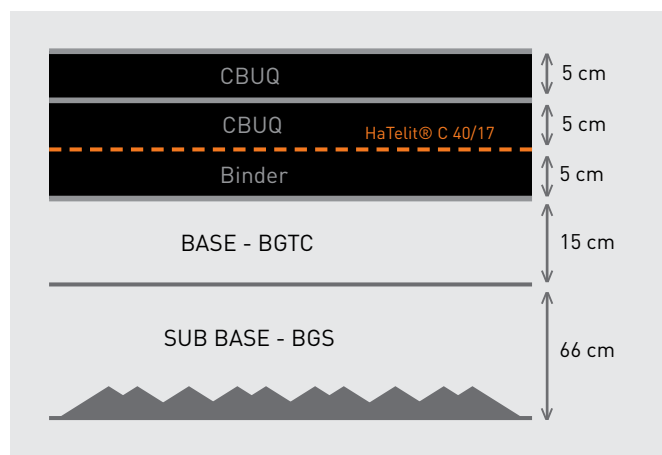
Pavimento executado nas áreas de taxejamento e pátio de aeronaves.
